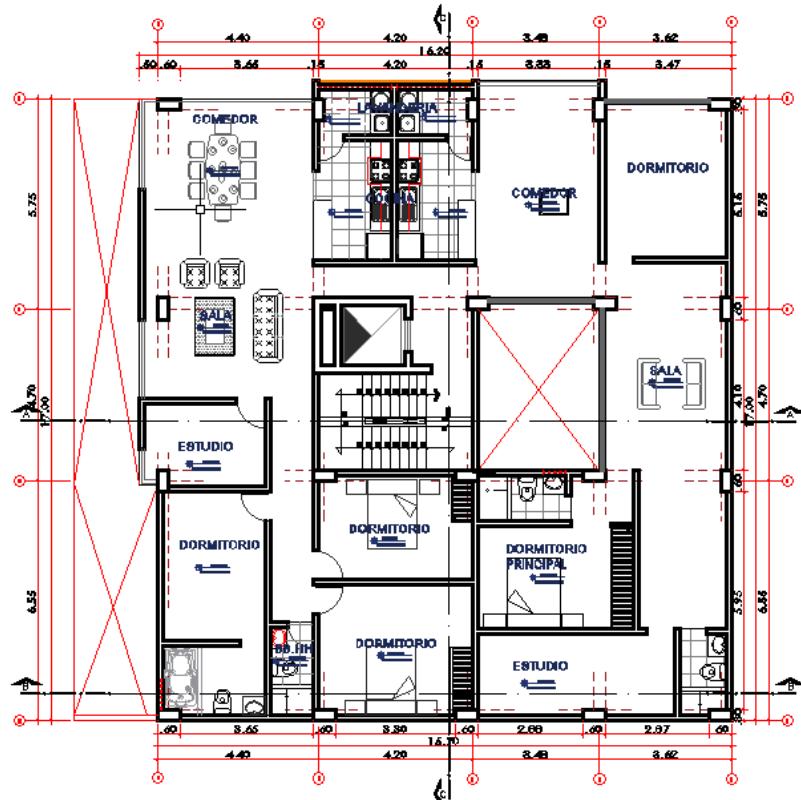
Plano Arquitectónica Tercer al Quinto Nivel
